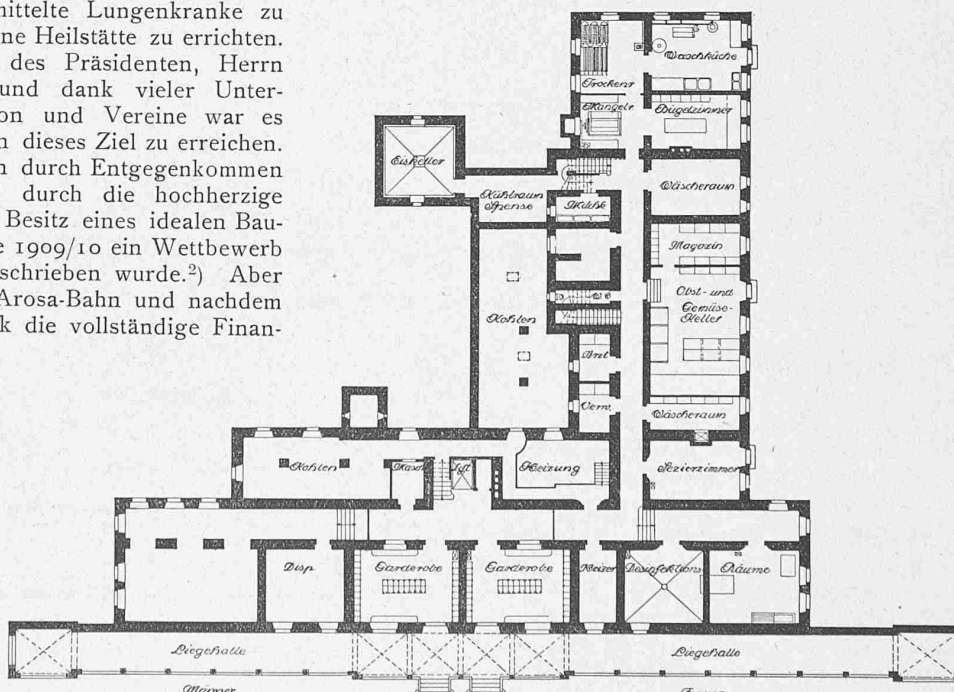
Grundriss vom Untergeschoss. — Masstab 1:500.
